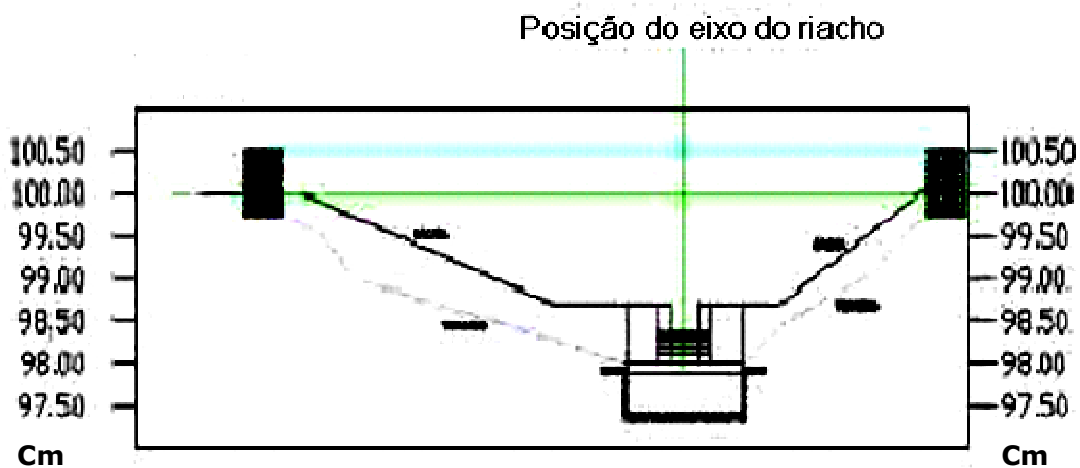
Corte transversal da seção do arroio com a posição da calha Parshall.
